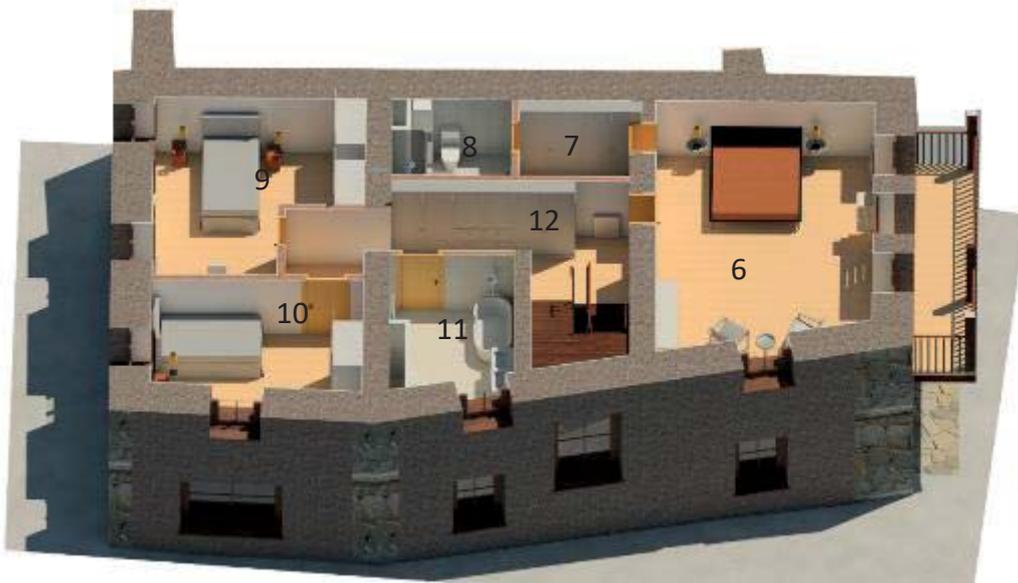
Render Planta Primera Vivienda. Fuente: propia
